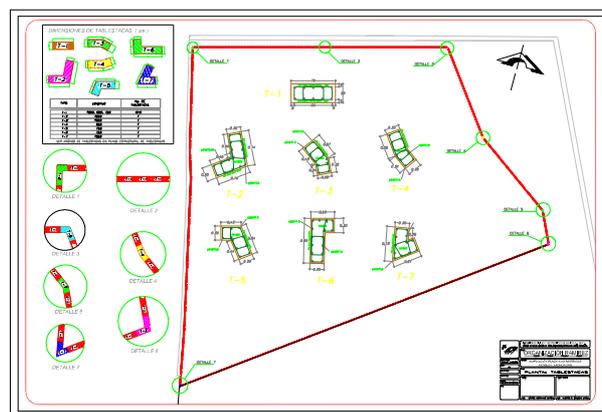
Plano de la planta de la colocación de las tablestacas y piezas de esquinas
